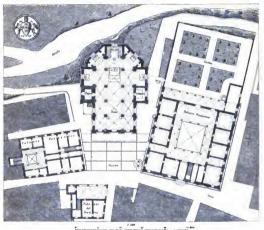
Dom und Palaste in Pienza, Grundriss, (Nach Mayreder.)
